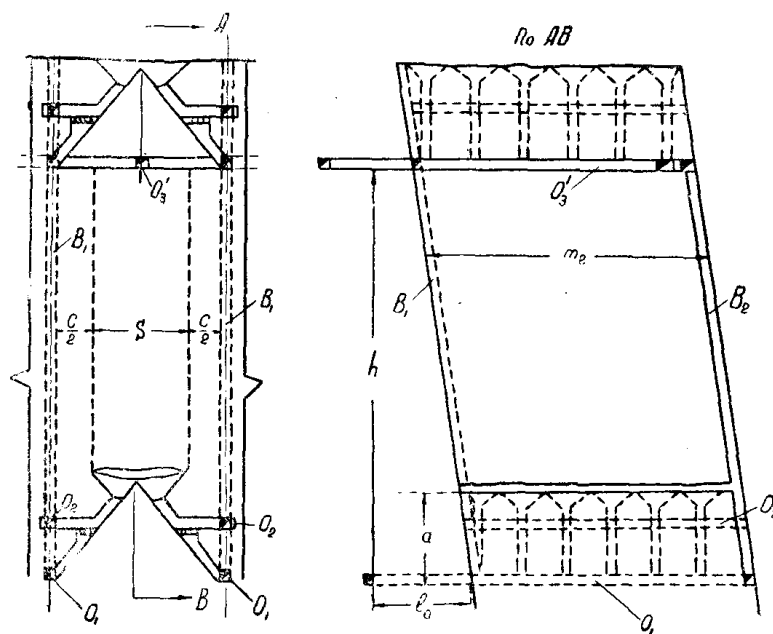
Схема подготовки камеры с этажной выемкой руды глубокими вертикальными скважинами (с горизонтом грохотов)
